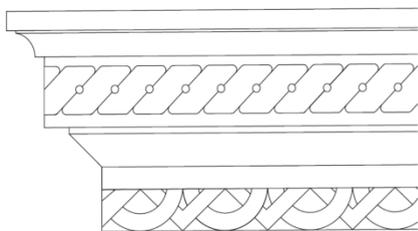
Убранство дома Попова, цифра 1 на фасаде
